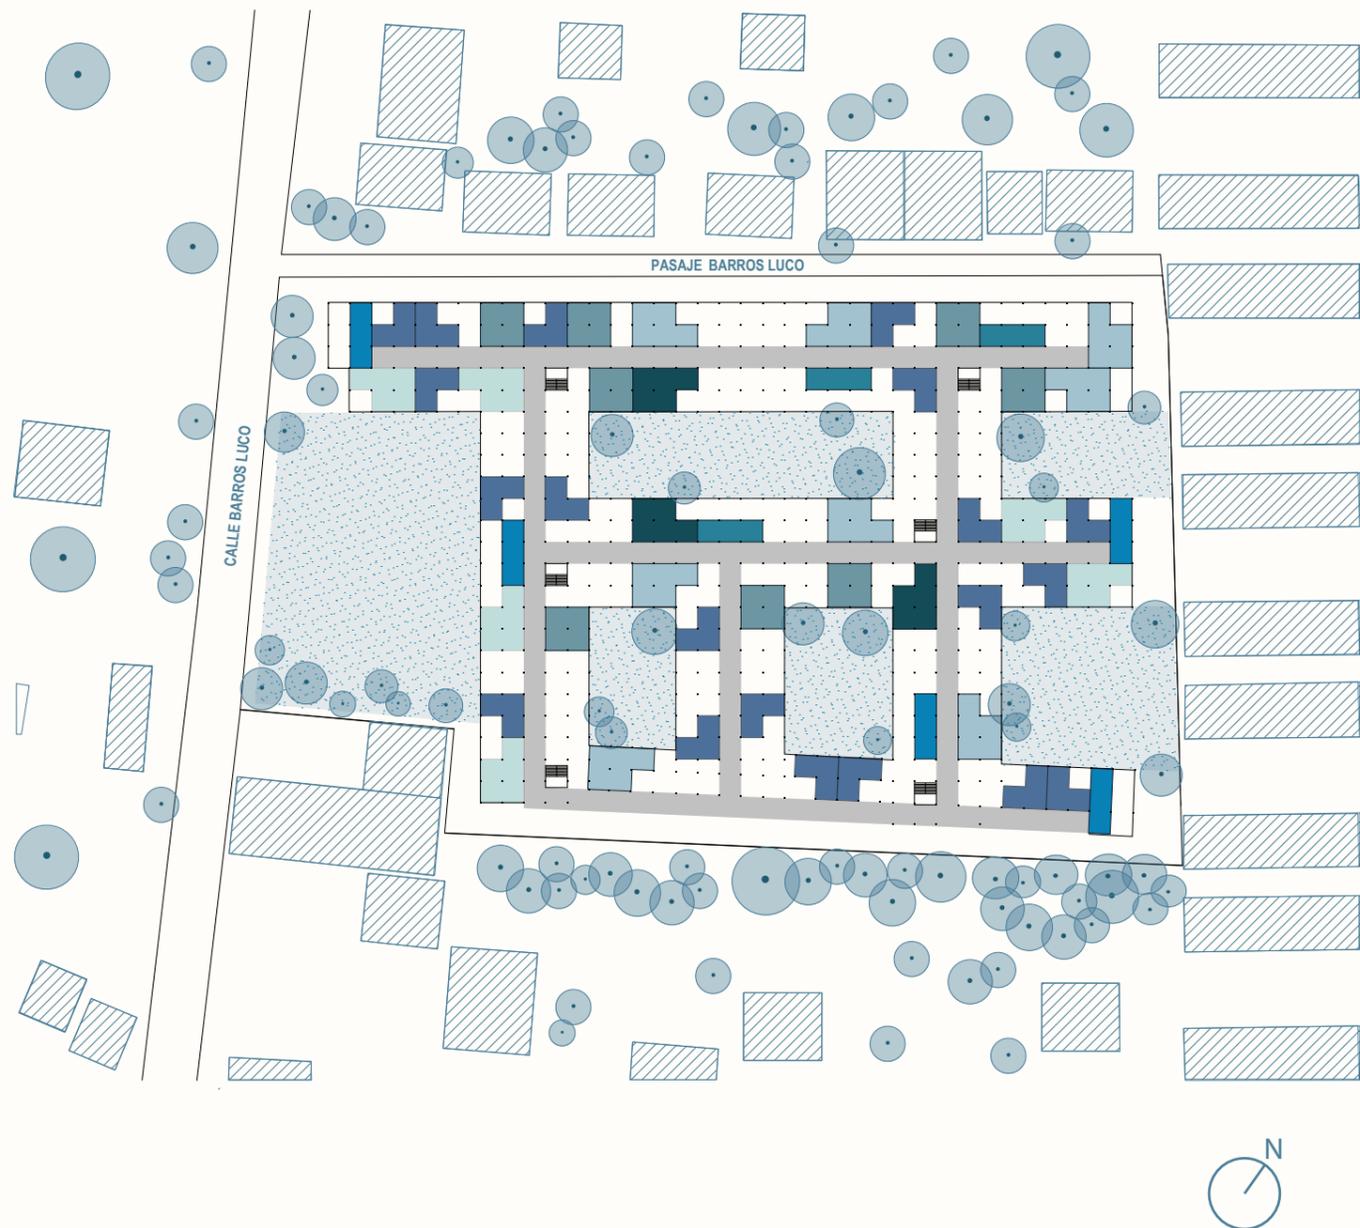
Planta de Emplazamiento. Fuente: Elaboración Propia.
